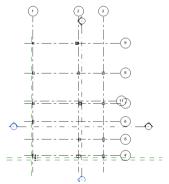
Planos de trabajo y rejillas. 2014. Elaboración propia.
